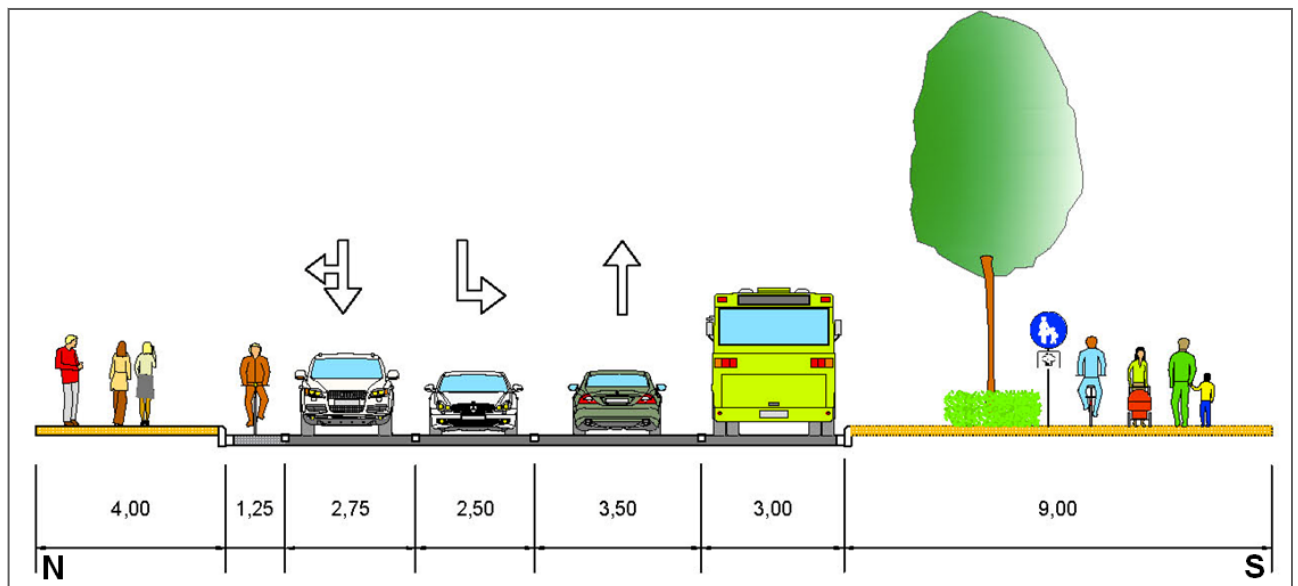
Kaiserstraße Querschnitt 4 (4)
